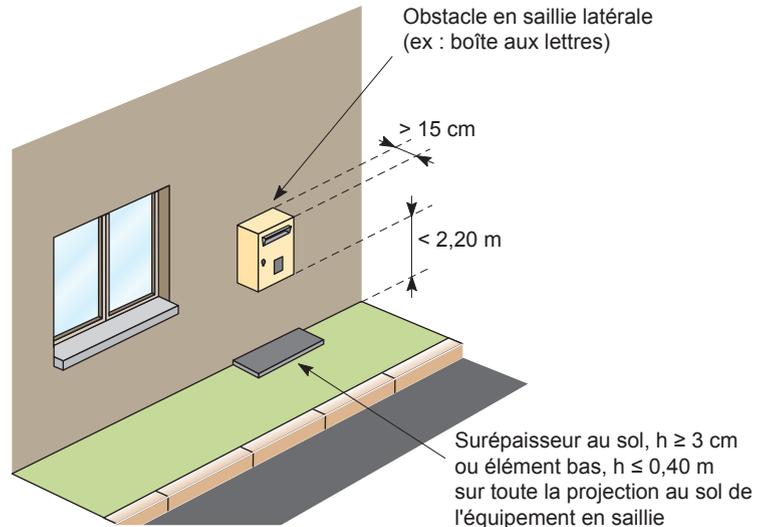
Repérage d'une boîte aux lettres en saillie latérale sur le cheminement.
